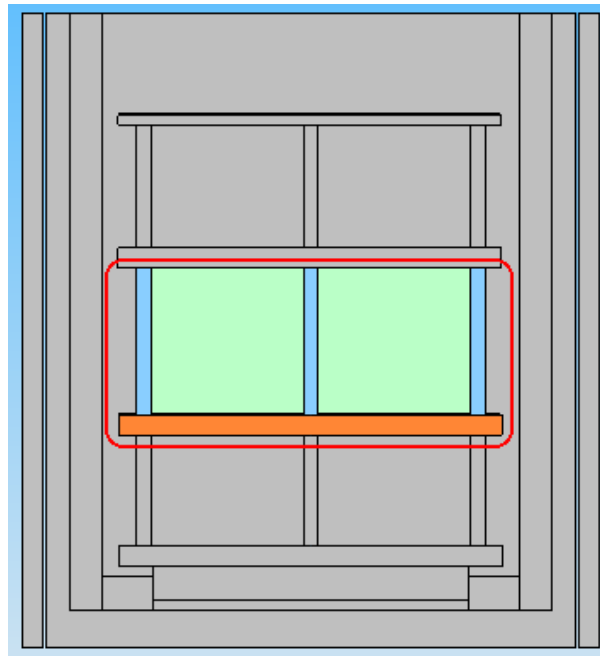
8: Detalle de la planta 2 en el interior del cubo
